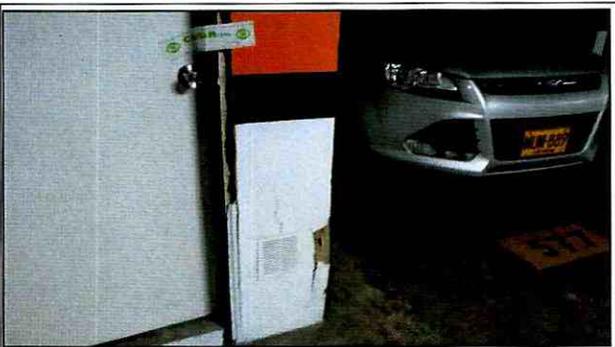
Vista de los daños observados en uno de los ductos de ventilación del sótano.
